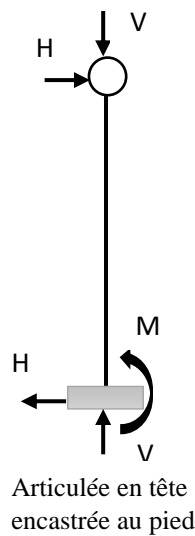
24: Poteau articulé en tête encastrée au pied.
